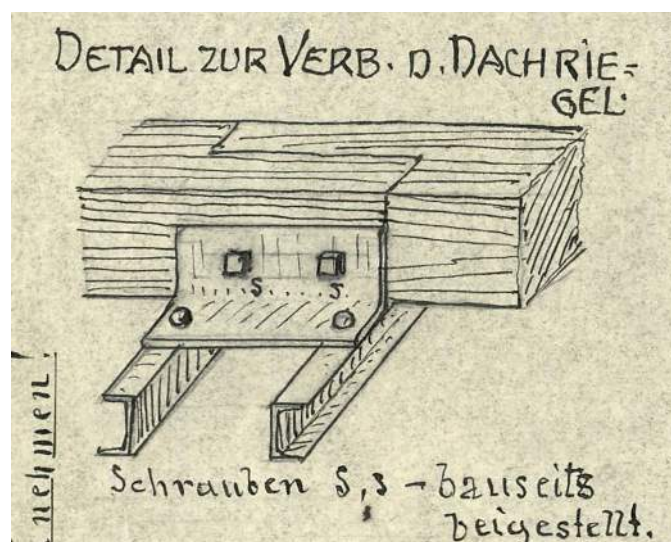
Schifterdetail für die Dachkonstruktion der Halle 64
